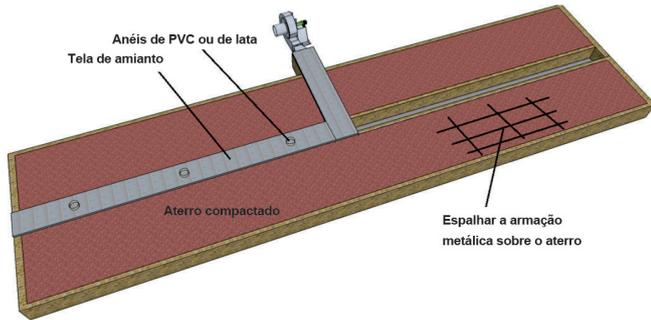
Desenho mostrando detalhes da construção do piso sobre aterro e dos canais com telhas de amianto.
